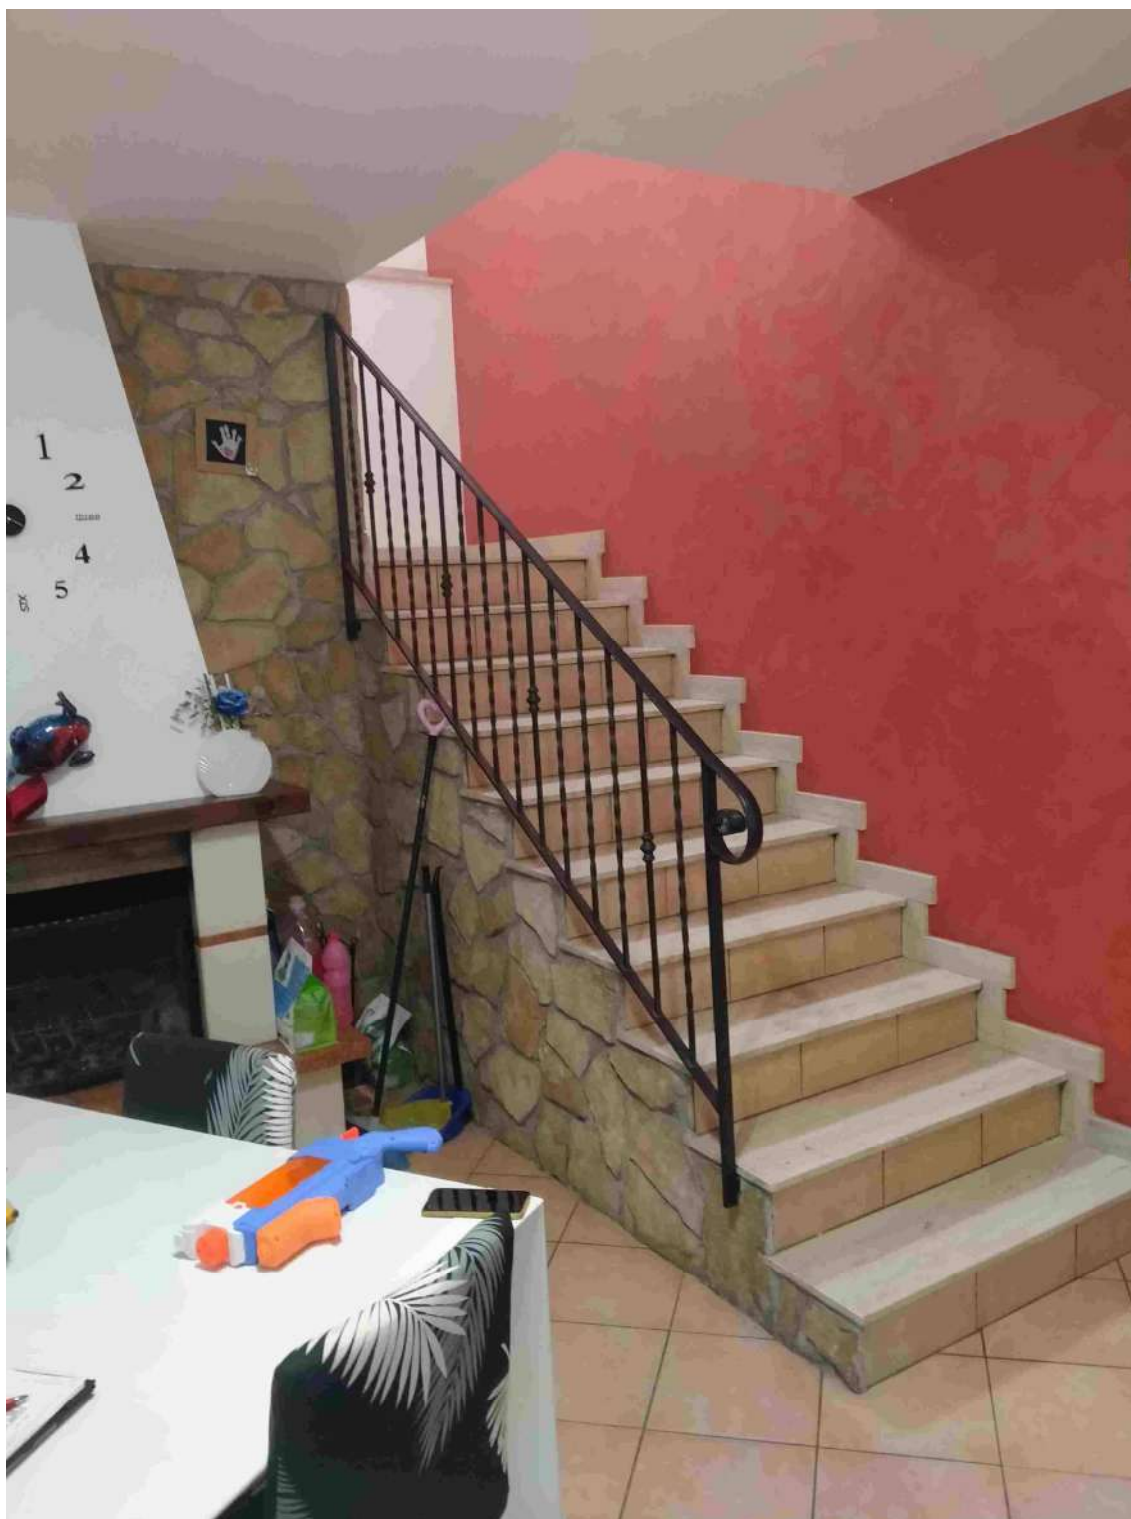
Scala che conduce al primo piano dal locale soggiorno.
